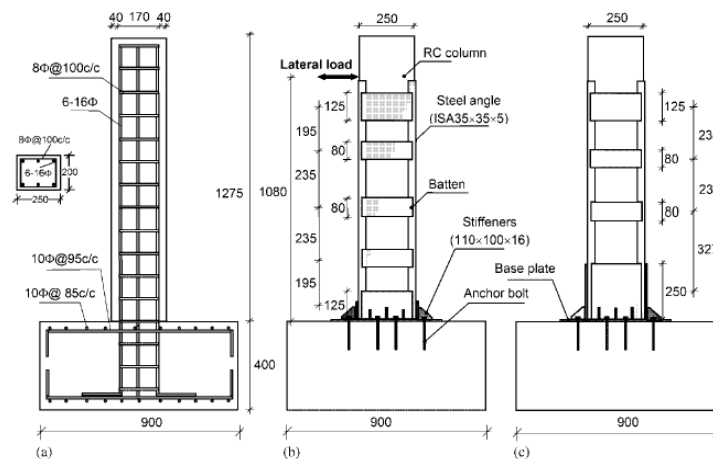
Geometría de las probetas. (Nagaprasad P. et al., 2009). a) detalles de armado, b) probeta reforzada RCO, (c) probeta reforzada RCS1
